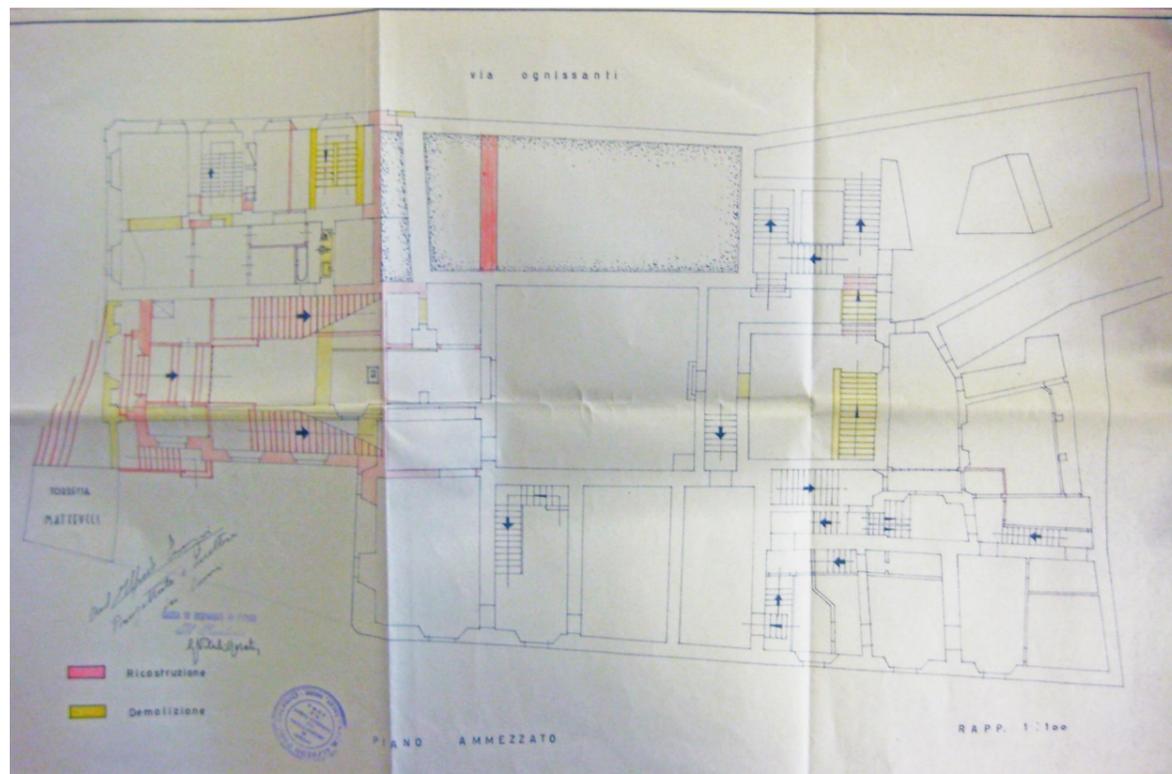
Pianta del piano ammezzato. Progetto dell'architetto Alfredo Energici. Archivio della Cassa di Risparmio.
